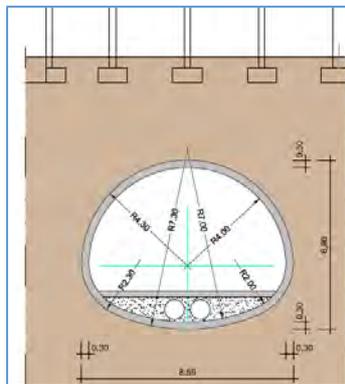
Secção transversal corrente dos Túneis de Acesso
